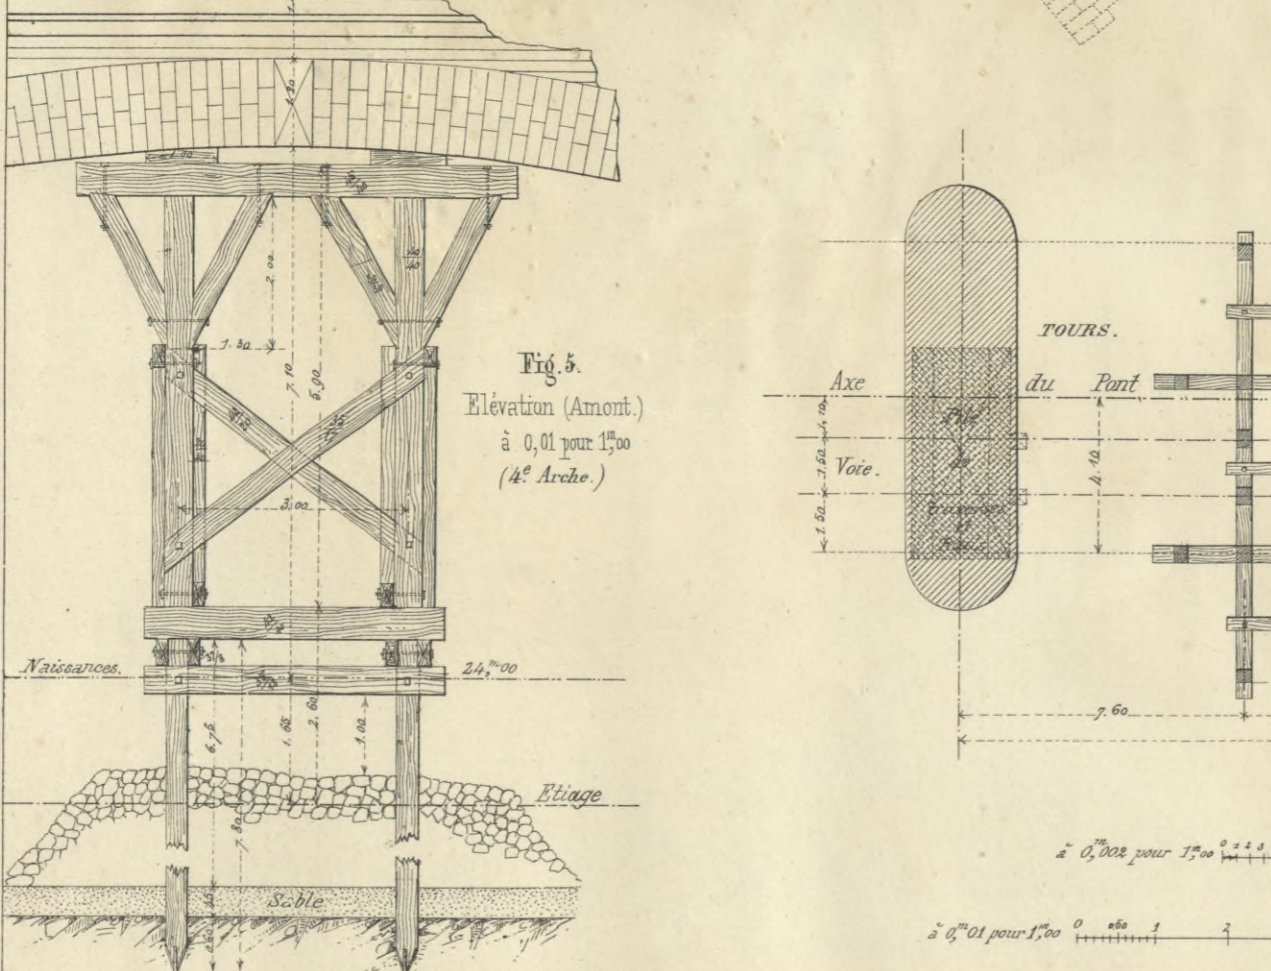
4^e Pile. Elevation (Amont) à 0,01 pour 1,00.
